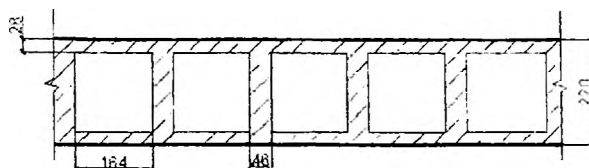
Железобетонная плита с эквивалентными квадратными пустотами
